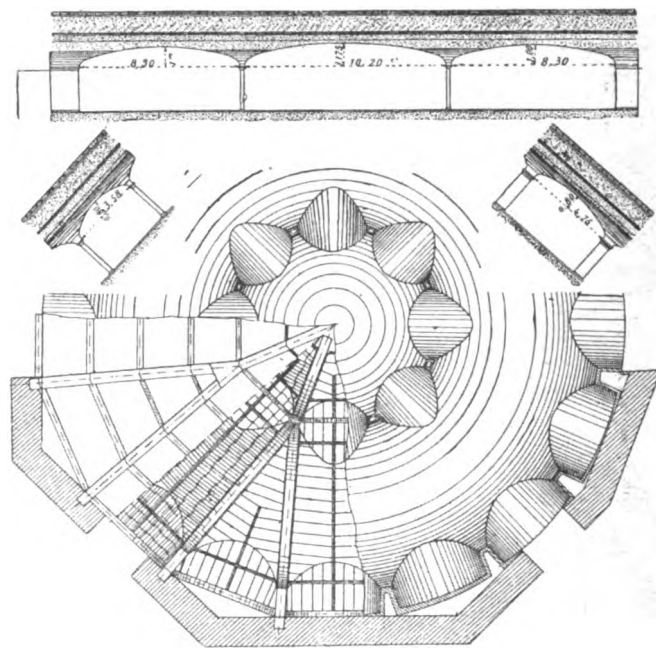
Sala sotterranea della «Place du Havre» - Pianta parziali e sezioni.
